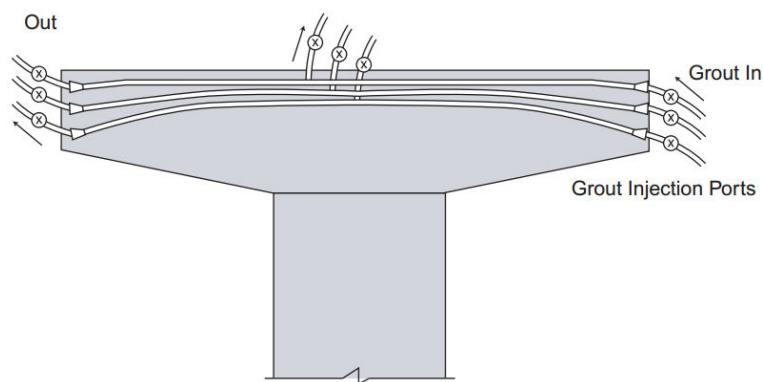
Detalles de grouting para tendones laterales en cabezal de pilar cabeza de martillo.
